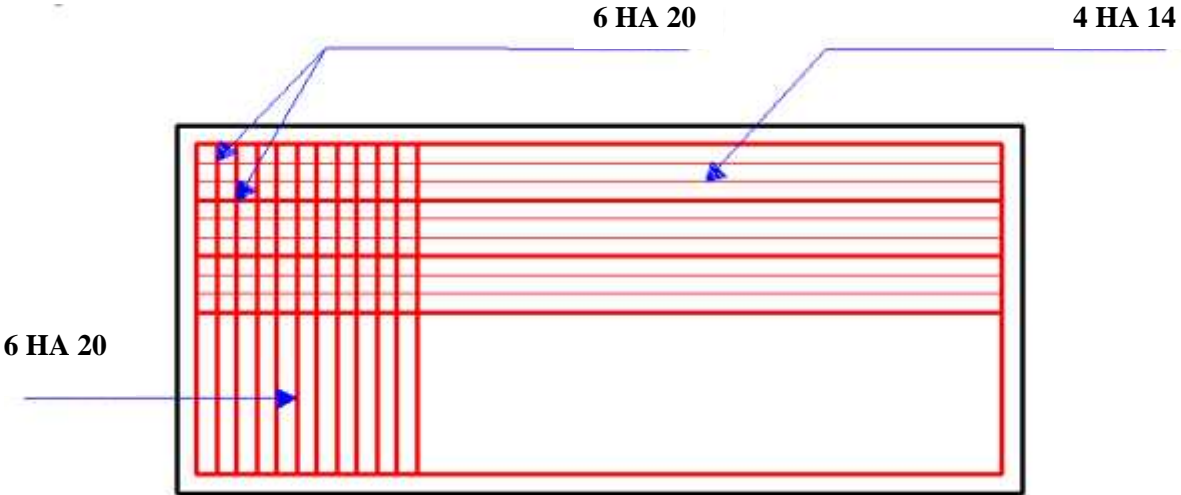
Schéma de ferrailage (nappe supérieur)
